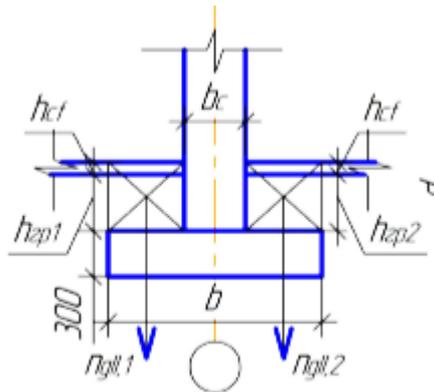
«Схема к определению веса грунта и пола на уступах фундаментной плиты» [12]
